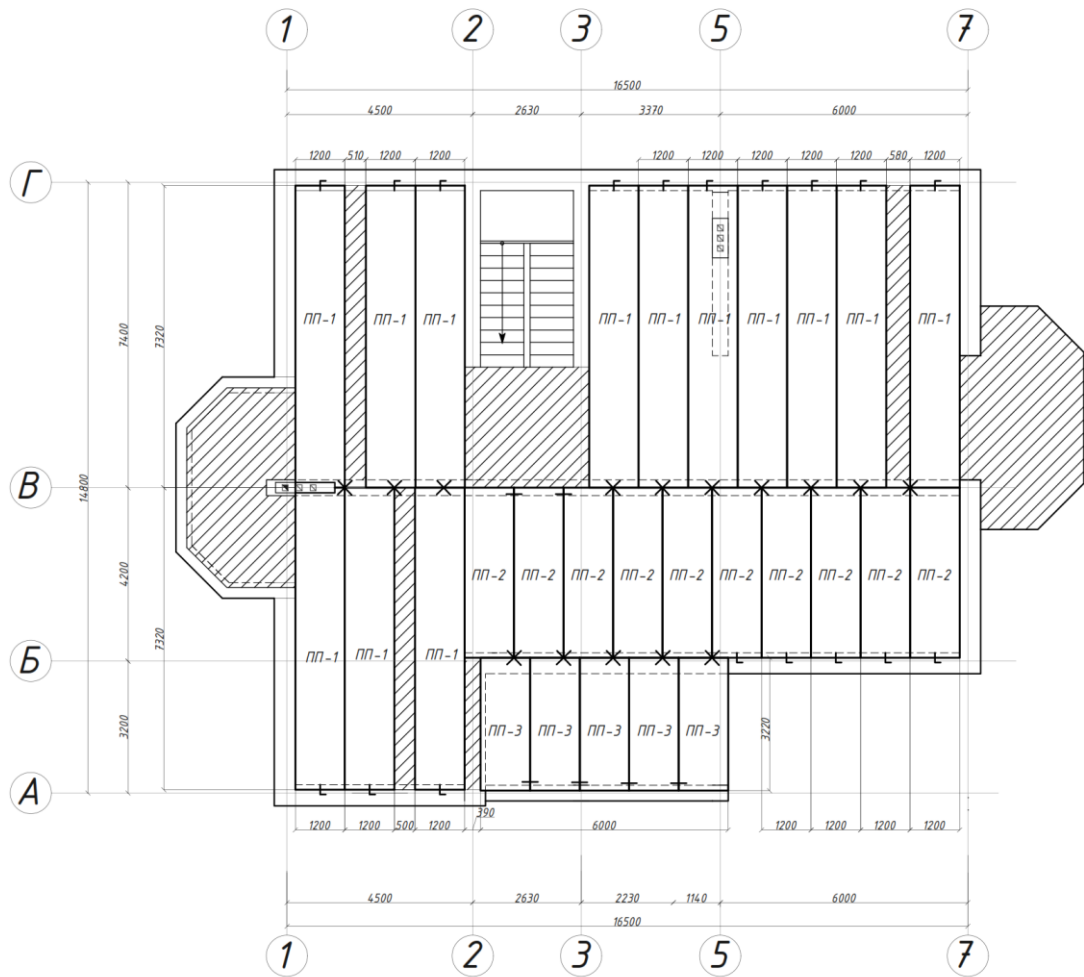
Конструктивна схема перекриття 1-го поверху
